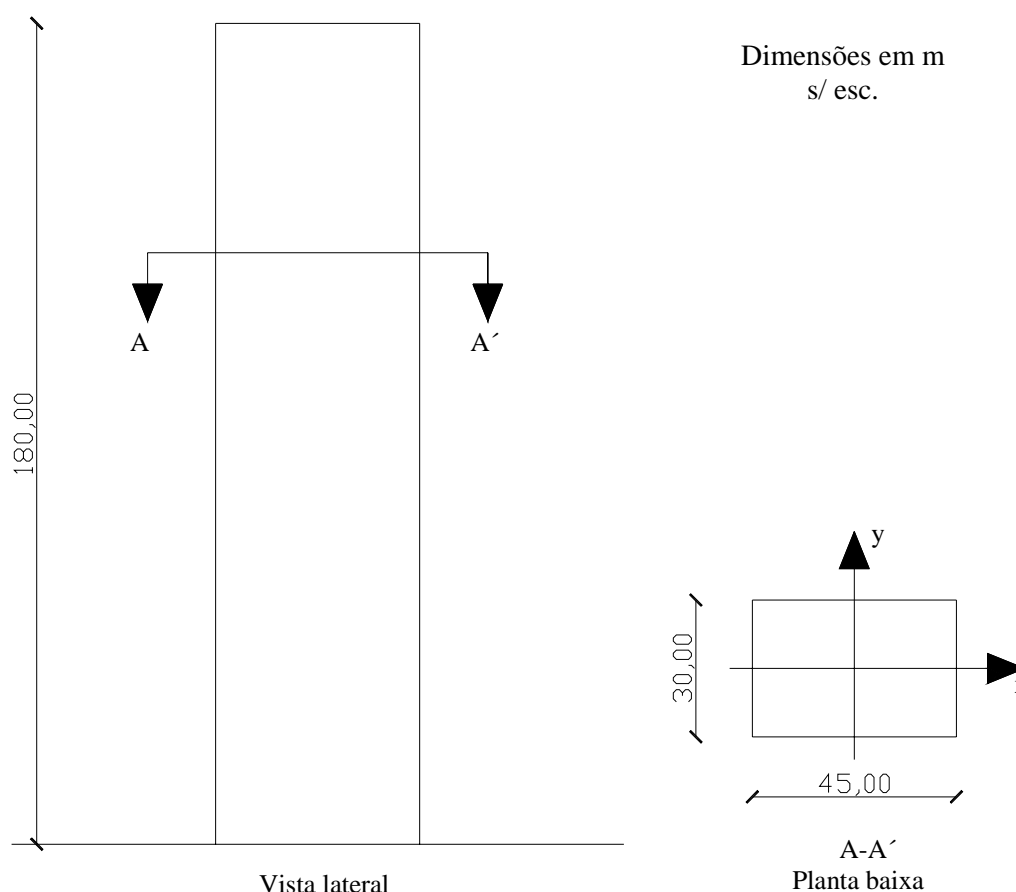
Planta baixa e vista lateral do “CAARC Standard Tall Building”.
